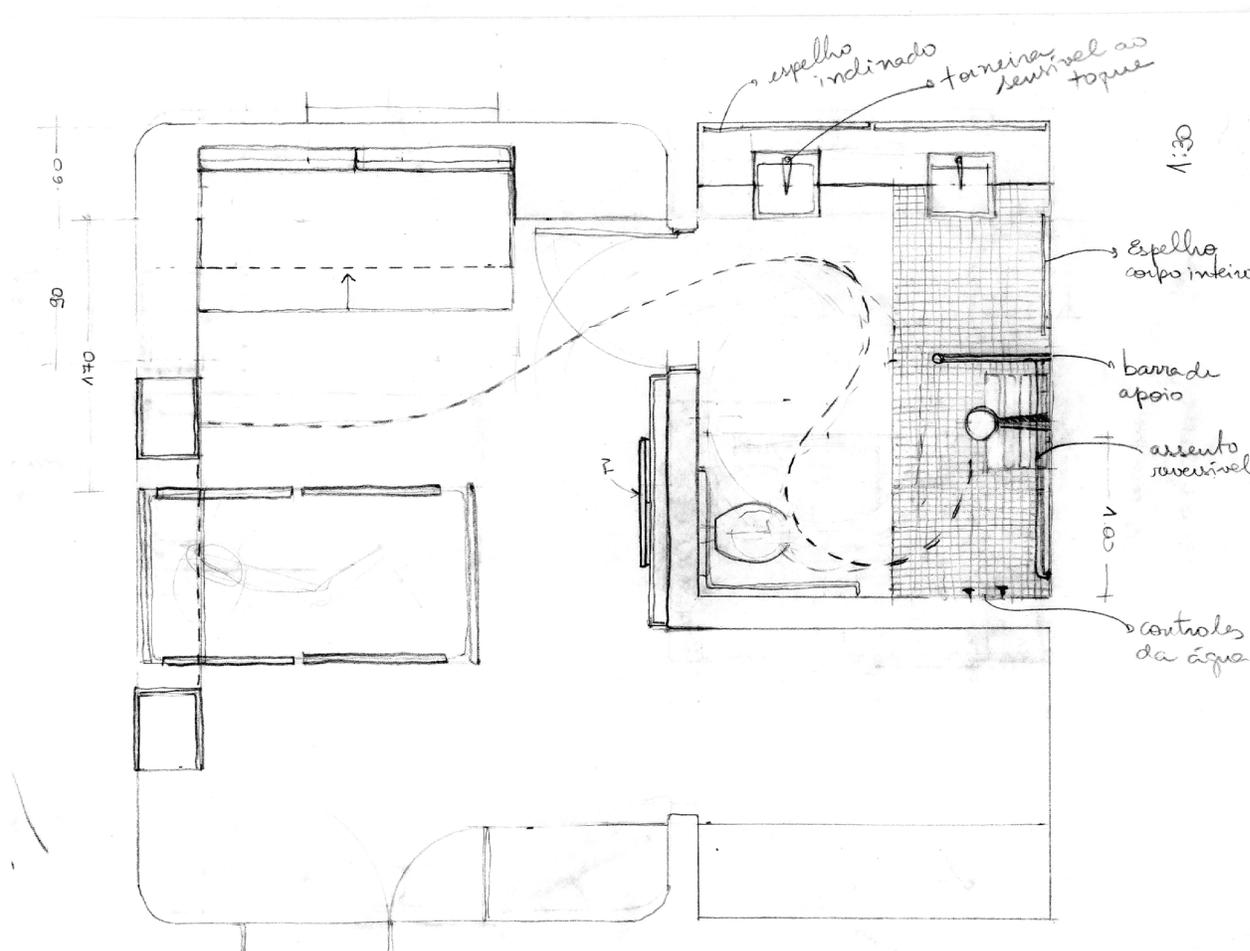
planta do primeiro estudo preliminar da suíte do estudo de caso 2.
